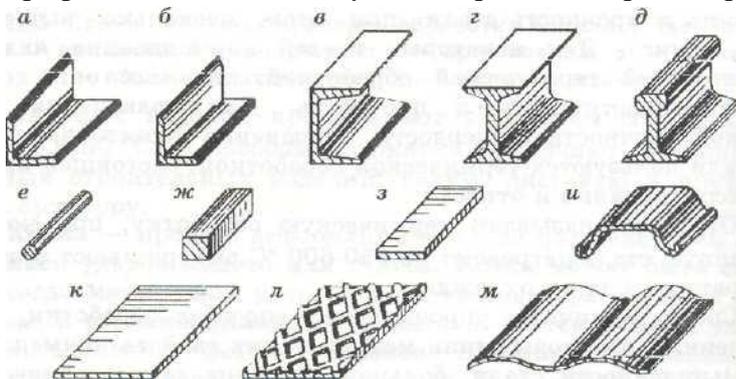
Прокатні вироби із сталі різного профілю: а —кутикова рівнобока; б — кутикова нерівнобока; в — швелер; г — двотавр; д — підкранова рейка; е — кругла; ж — квадратна; з —штабова; и — шпунтова паля; к — листова; л — рифлена; м — хвиляста.
